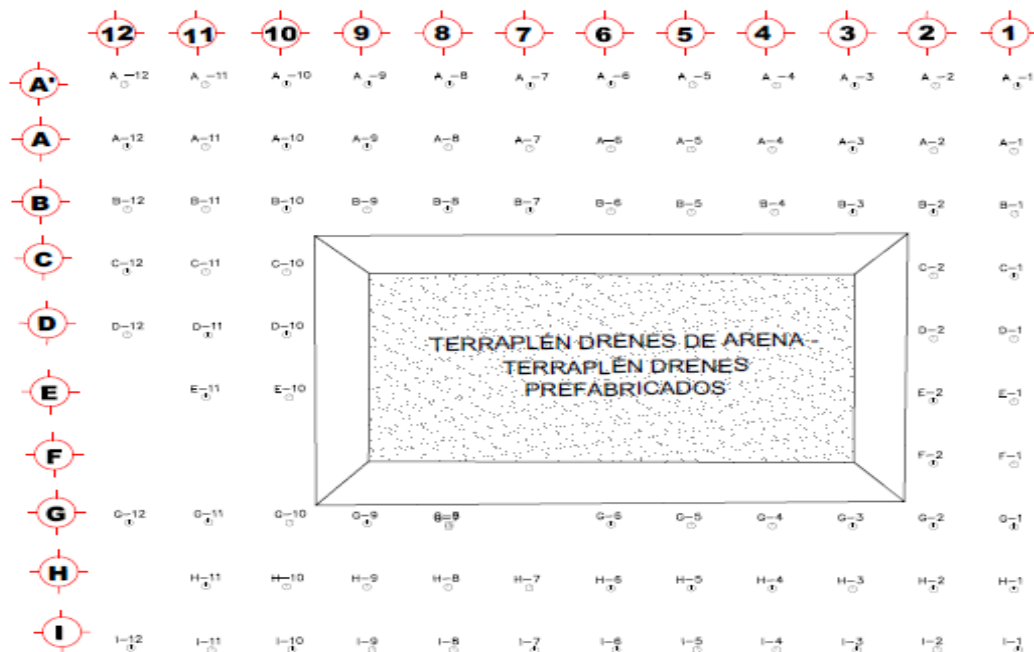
Disposición en planta de los inclinómetros en el TPDV
